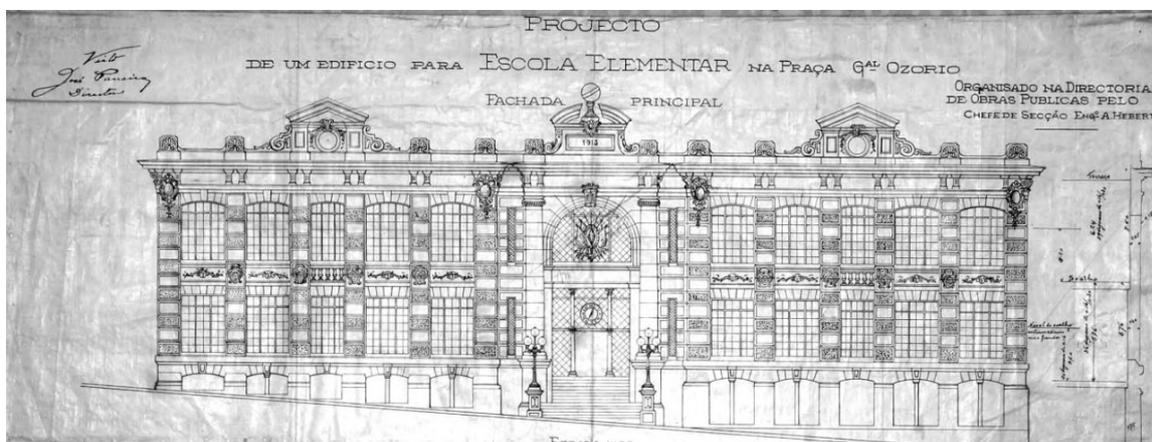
Fachada Escola Elementar, projeto de Hebert.
